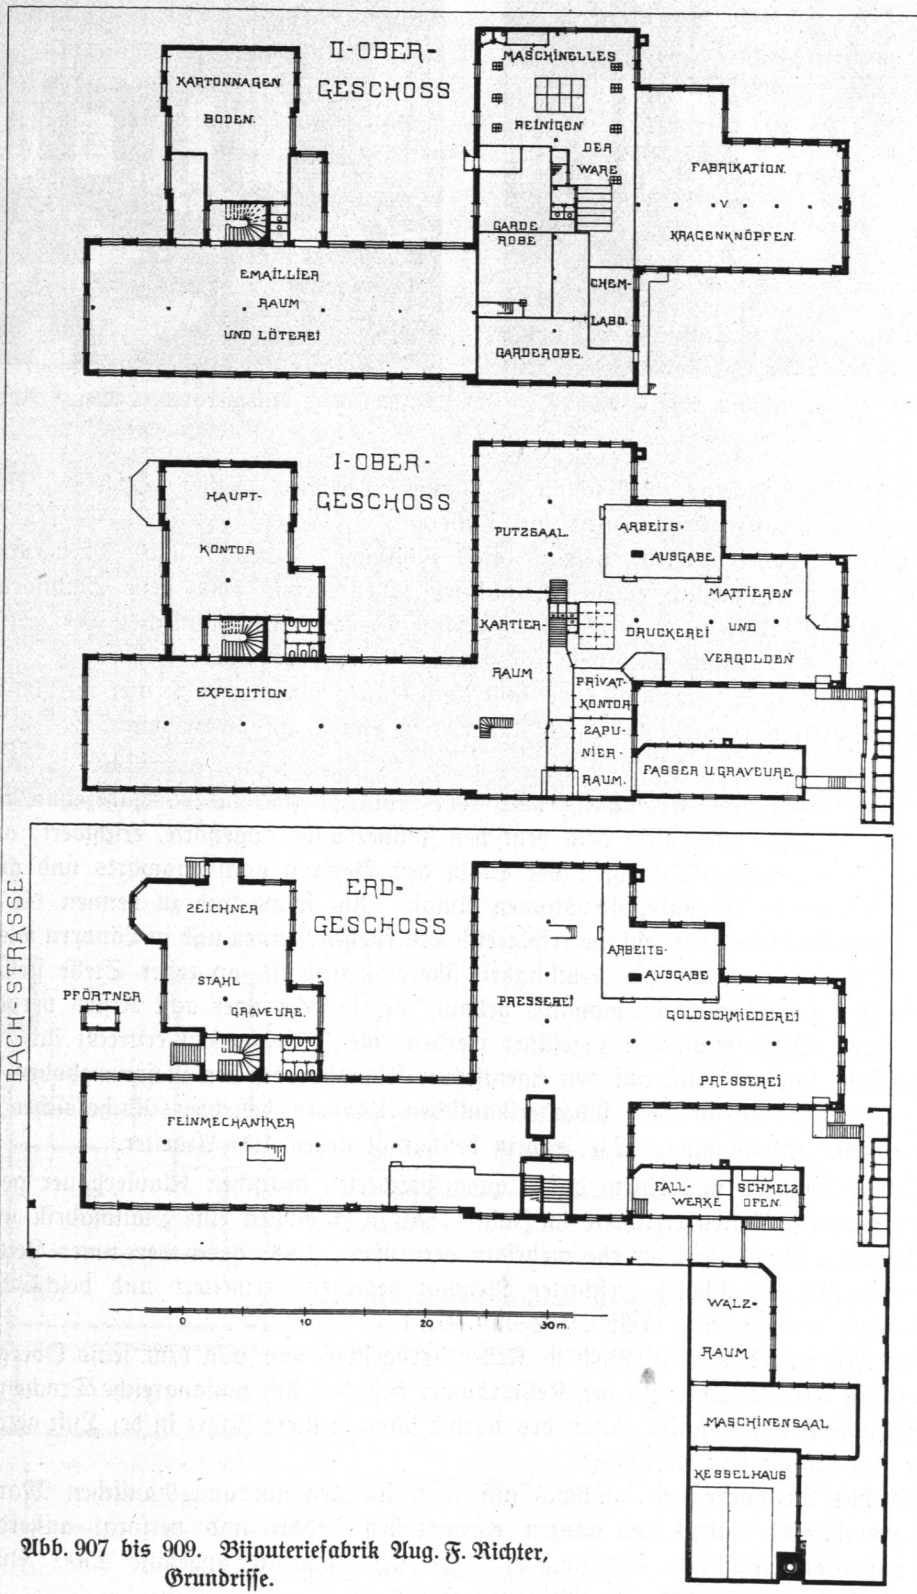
bis 909. Bijouteriefabrik Aug. F. Richter, Grundrisse.
